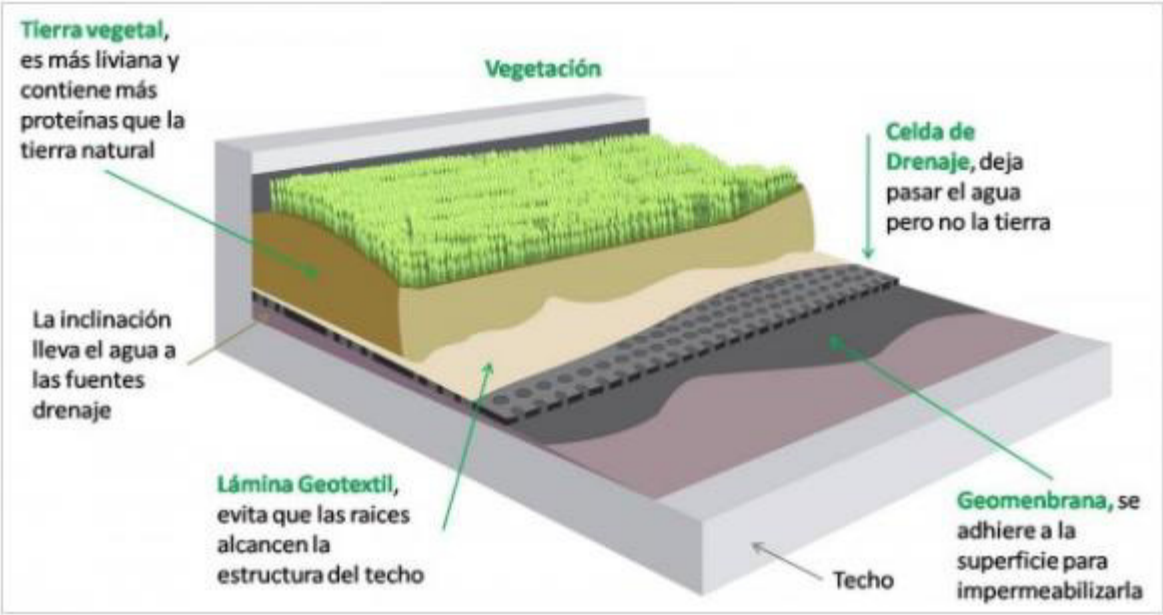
Capas y materiales que componen una cubierta de techo verde.
